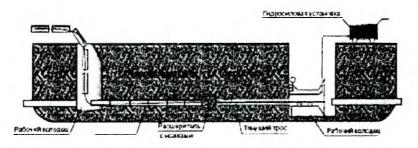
Бестраншейная замена трубопроводов с уменьшением проходного сечения (без разрушения старой трубы)
